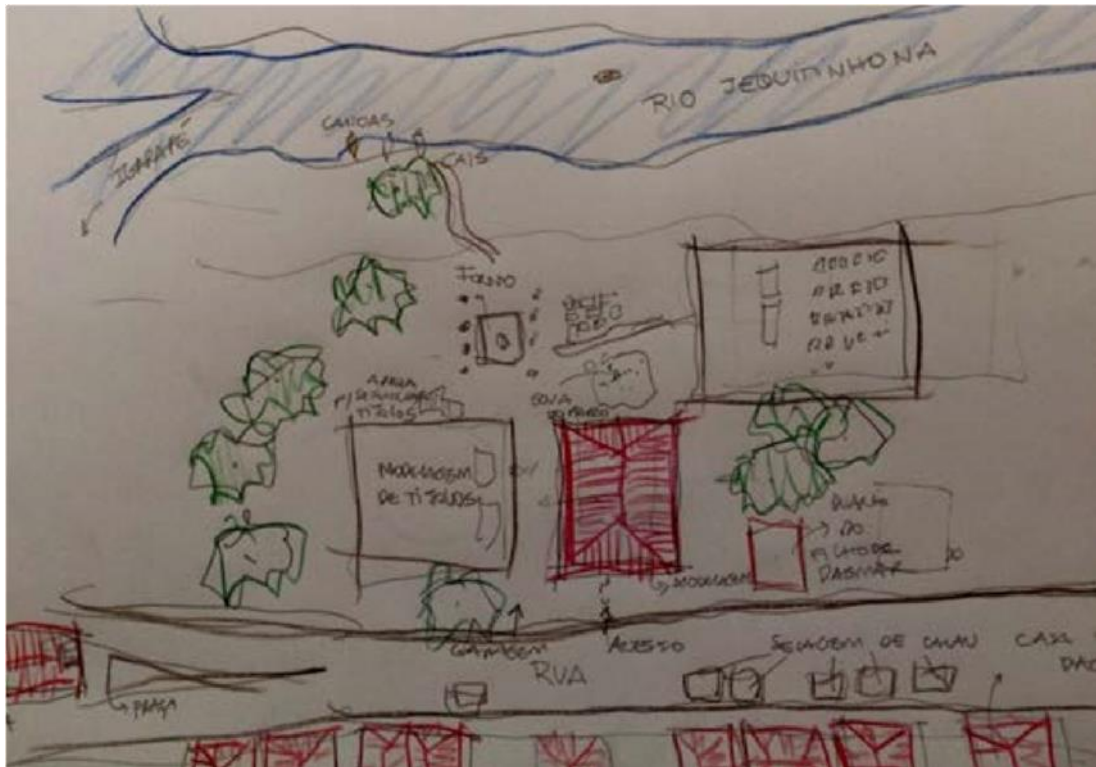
Planta Baixa da Cerâmica 14 Irmãos
